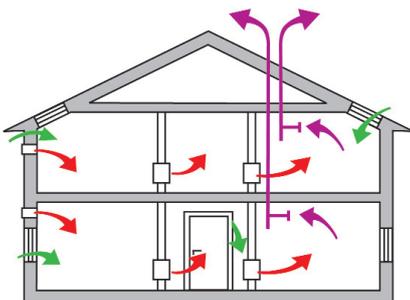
Ventilatorgestützte Lüftung, mit Installationsschacht
